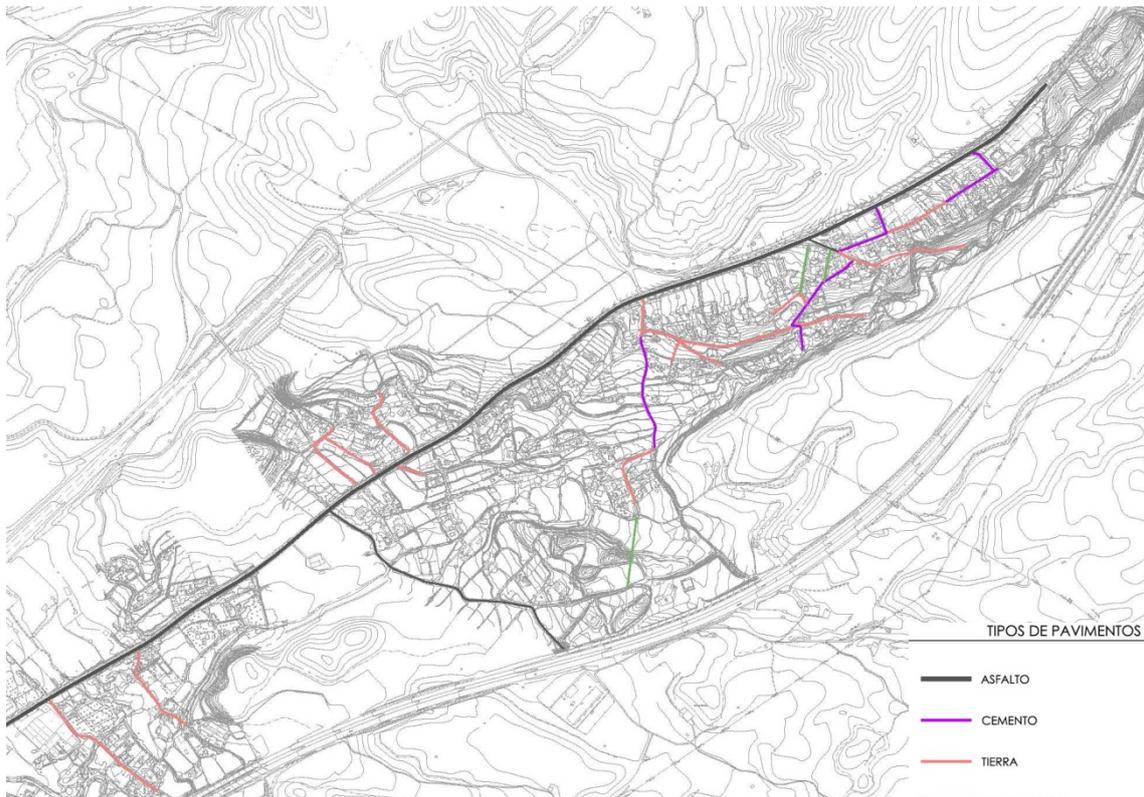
Extracto del Plano IB-08-Estado actual Pavimentación
